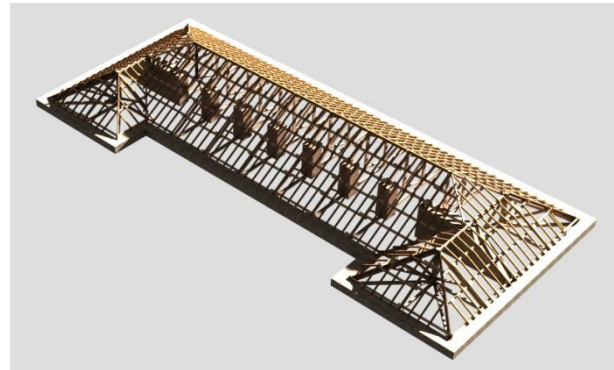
Animación planta de cubierta. (Elaboración propia; Allplan).
